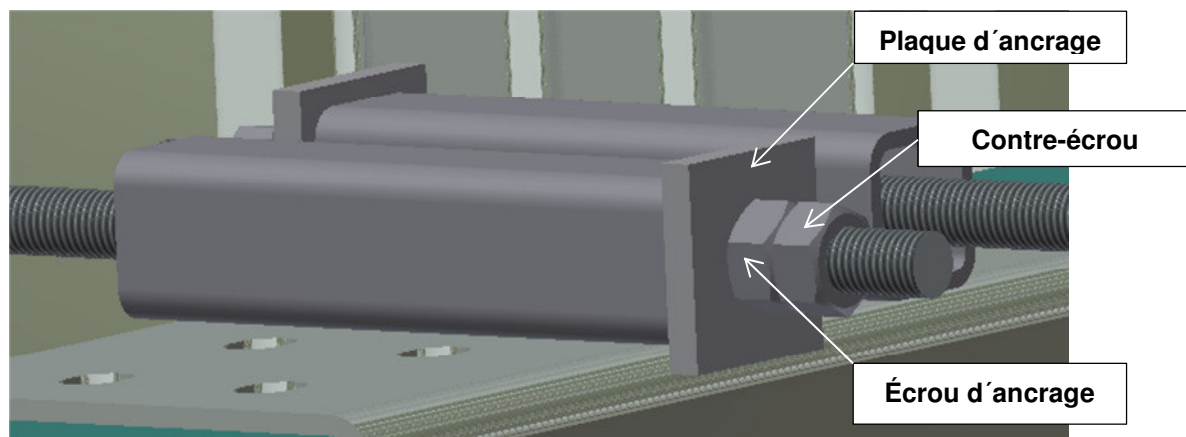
Détail de la vis avec la plaque d'ancrage et un contre-écrou
